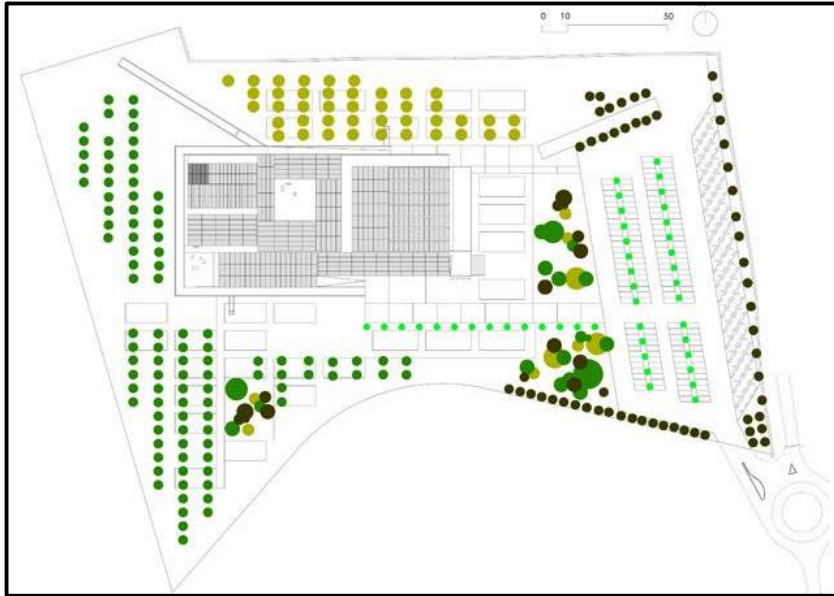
plan, de masse du musée Madinat Al-Zahra
